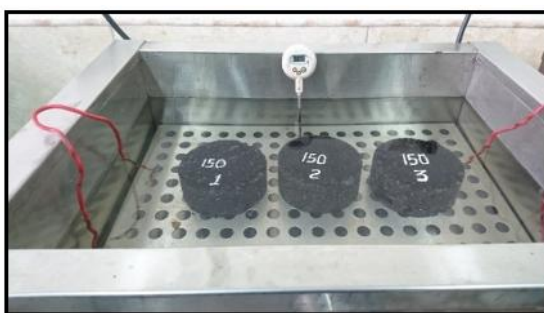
Briquetas en el baño maría a 60°C y secado de la superficie
